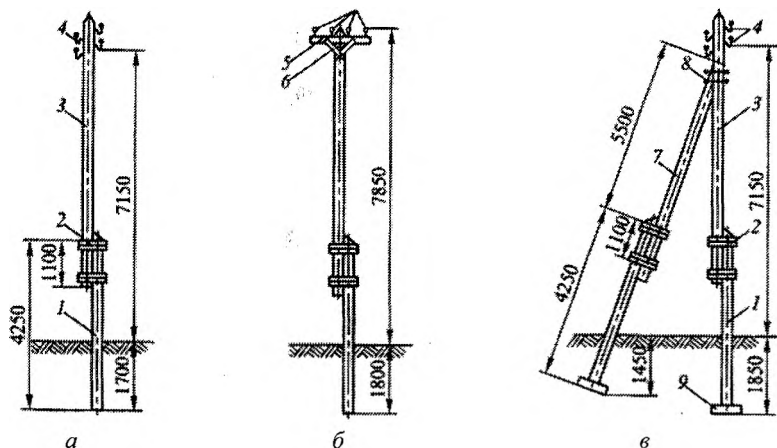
Дерев'яні опори для ПЛ з напругою до 1 кВ:
